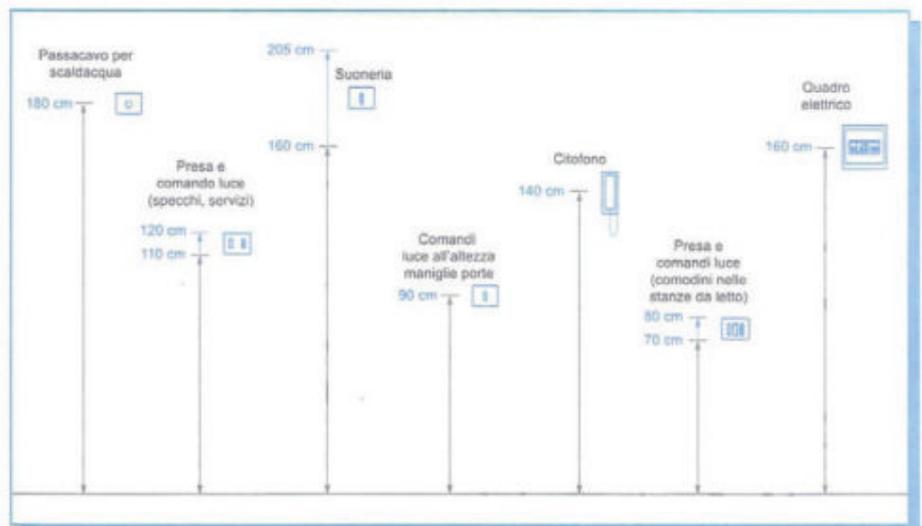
Quote di installazione delle apparecchiature negli edifici civili, secondo la guida CEI 64-50.
